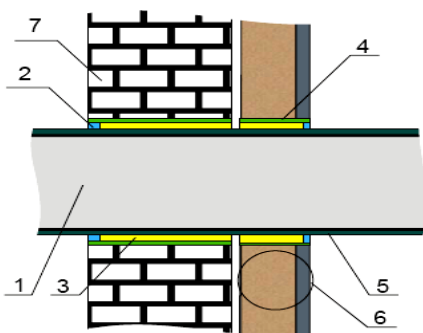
Схема прокладки вентиляционных каналов через стены. 1 – вентиляционный канал; 2 – виброакустический силиконовый герметик; 3 – упругая прокладка; 4 – гильза; 5 – вибродемпфирующий материал; 6 – звукоизоляционная или звукопоглощающая облицовка; 7 – стена или перегородка.
